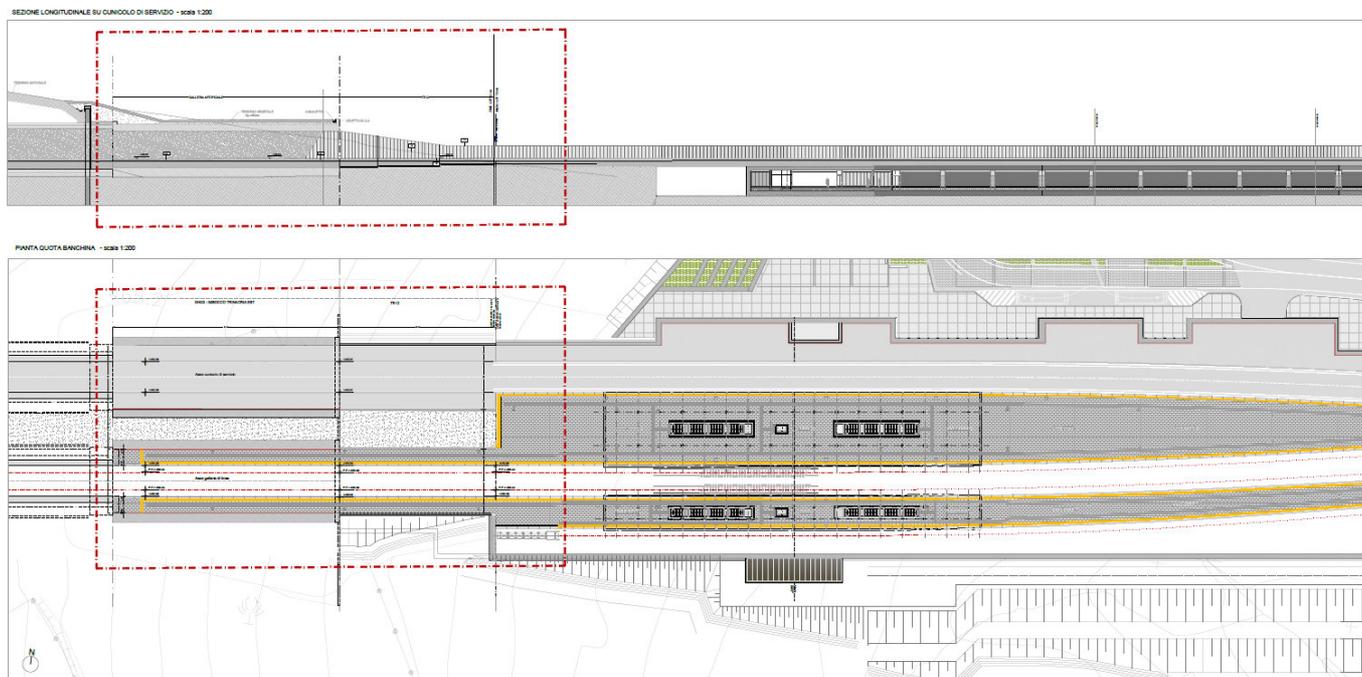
Stazione Nuova Enna – pianta e sezione longitudinale area di intervento
